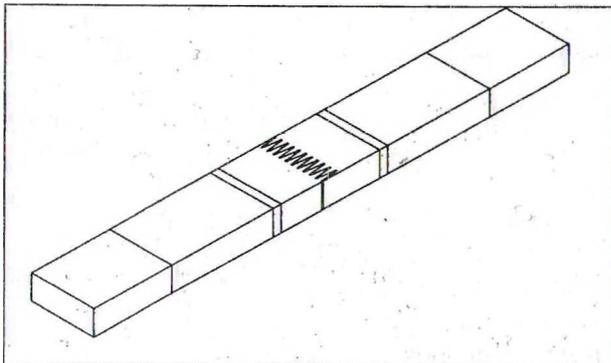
Твердотельная модель соединения на зубчатый клеевой шип
